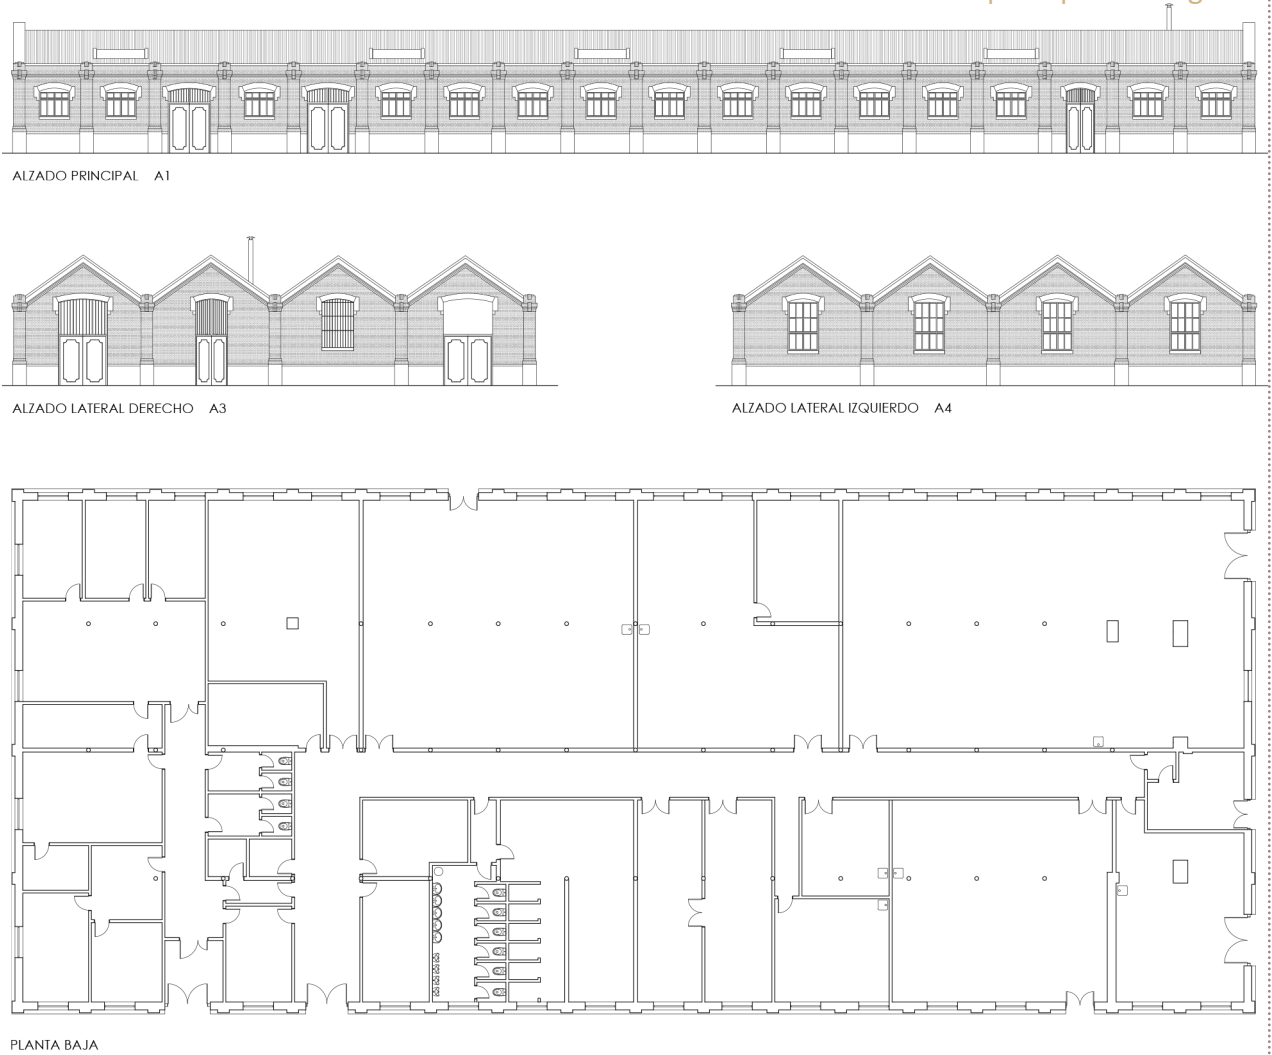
Planta y alzados del estado actual. Documentación facilitada por la Unidad Técnica de Arquitectura de la UVA.
